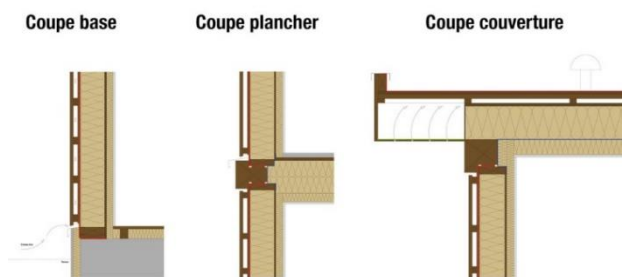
Système constructif poteau poutre (source : <https://ec-bois.com/nos-services/poteau-poutre/>, consulté le 20/05/2019 à 14h55).
